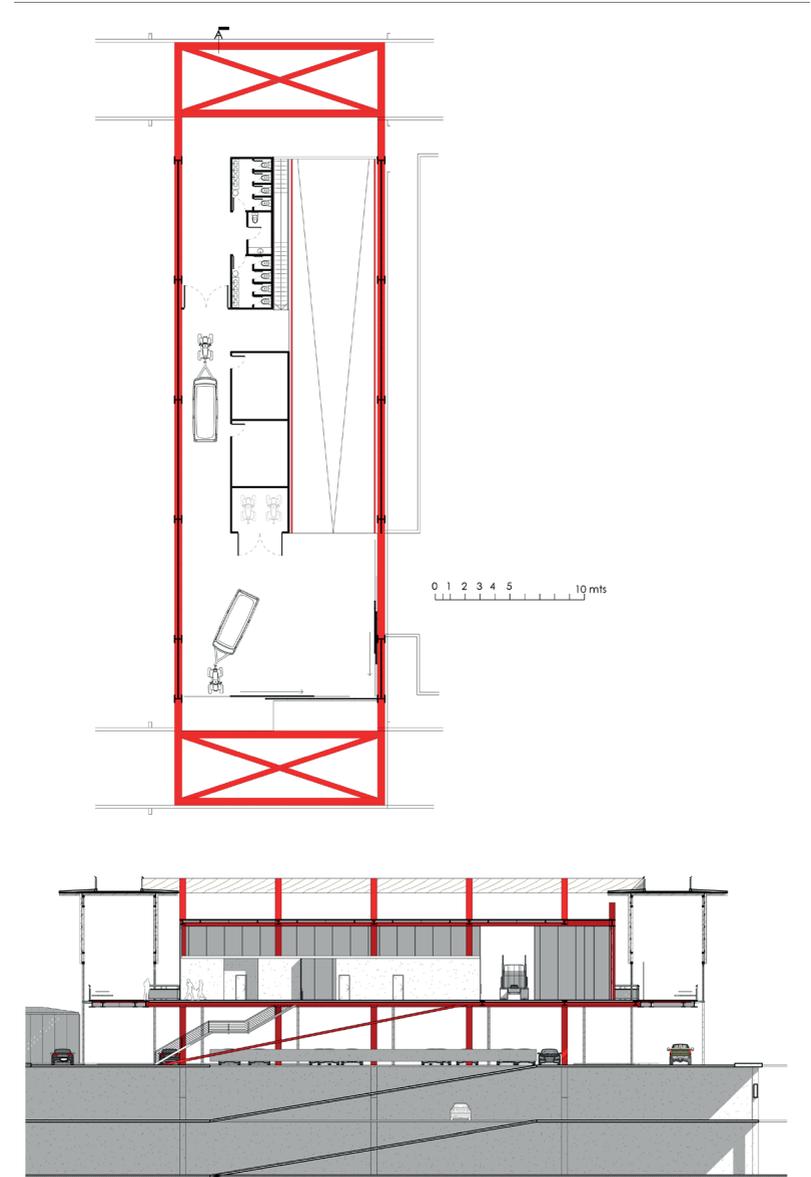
Corte y planta mediador Esclusa oculta al exterior. (2021). Planimetría. Elaboración propia.
